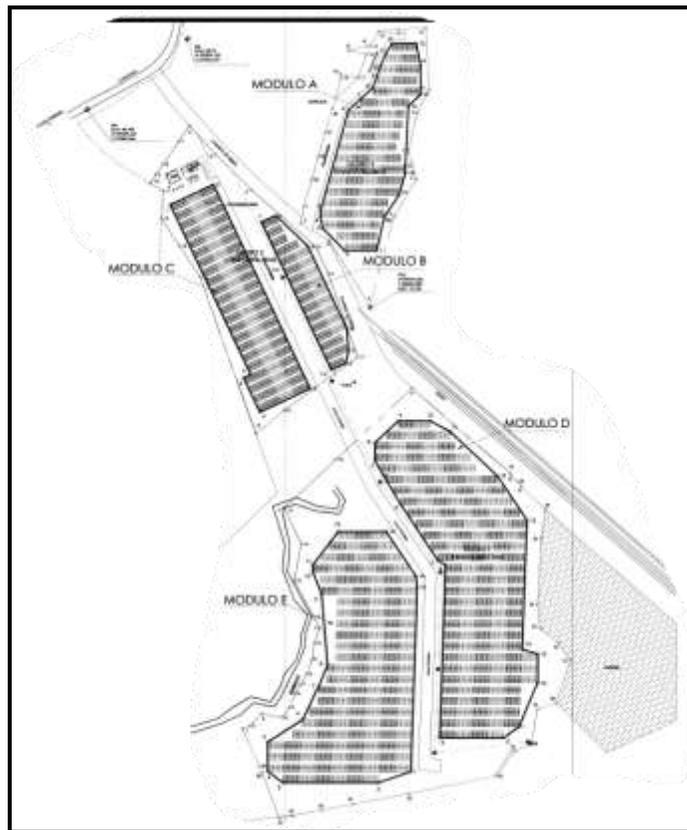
Distribución de paneles en el lote. Fuente: planos del proyecto.
